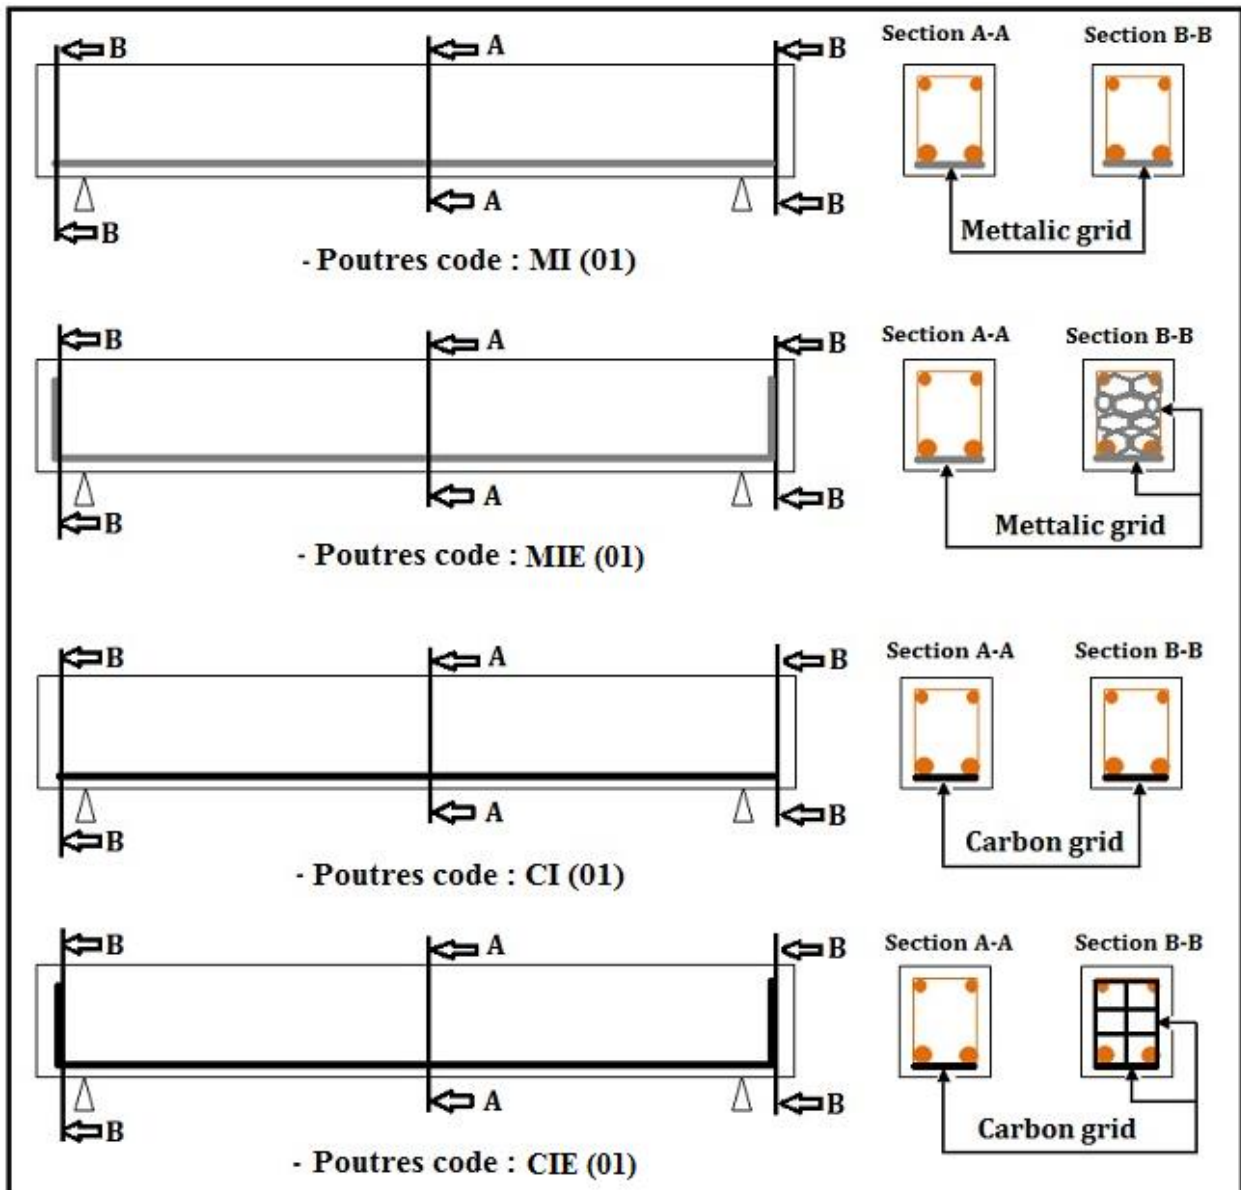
a : Détails de renforcement des poutres du groupe 01.
